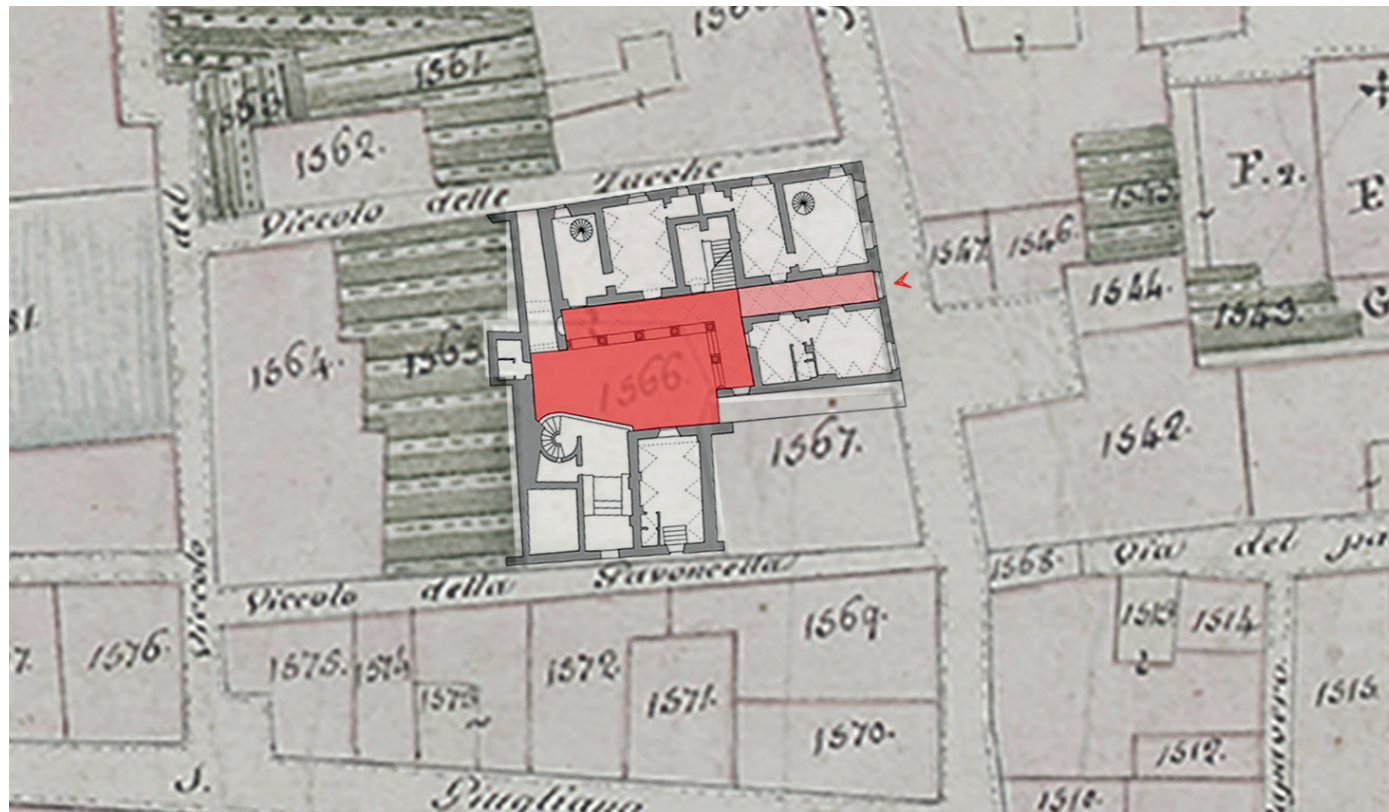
Lo schema in planimetria evidenzia l'ingresso principale, l'androne e il cortile aperto sul giardino.
